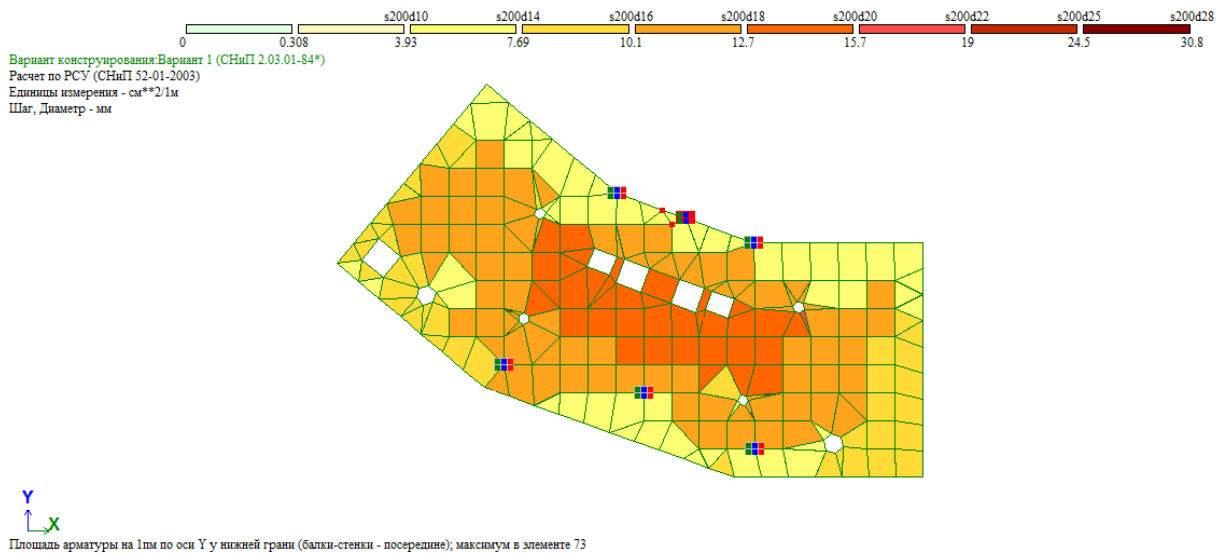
Площадь нижней арматуры вдоль цифровых осей
